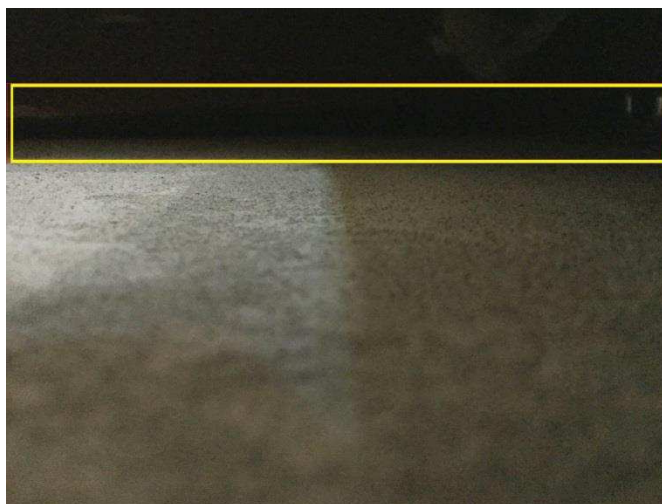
Неплотное примыкание настила кровли с основной стеной.
